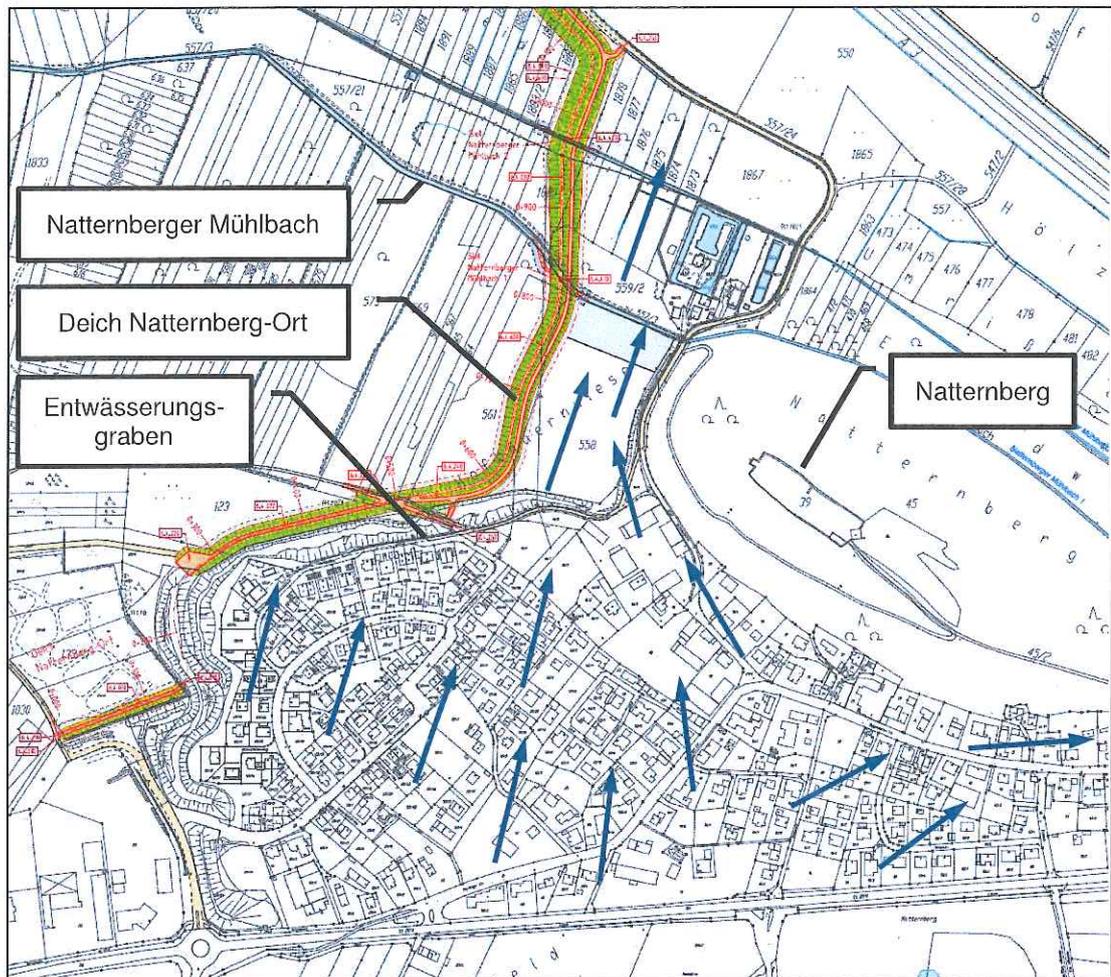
Lageplan Deich Natternberg (Ausschnitt aus Beilage 29 der PV-Unterlagen)
